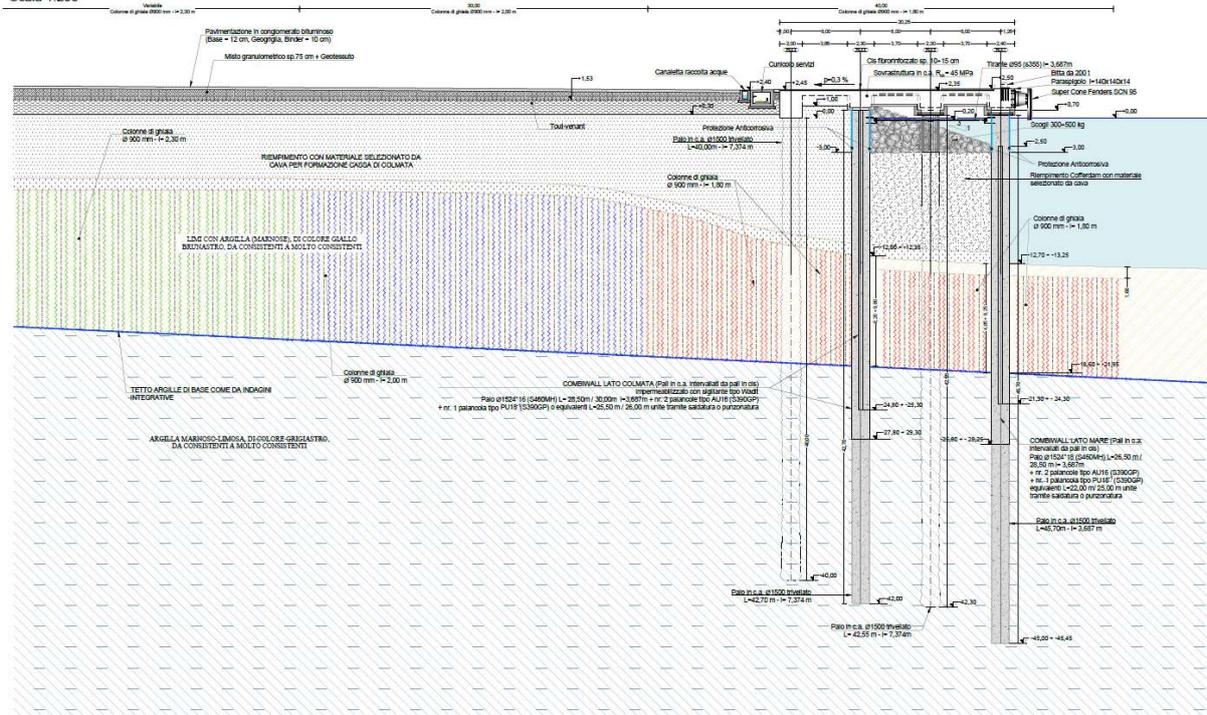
Banchina di Testata – Sezione “Tipo 4”
